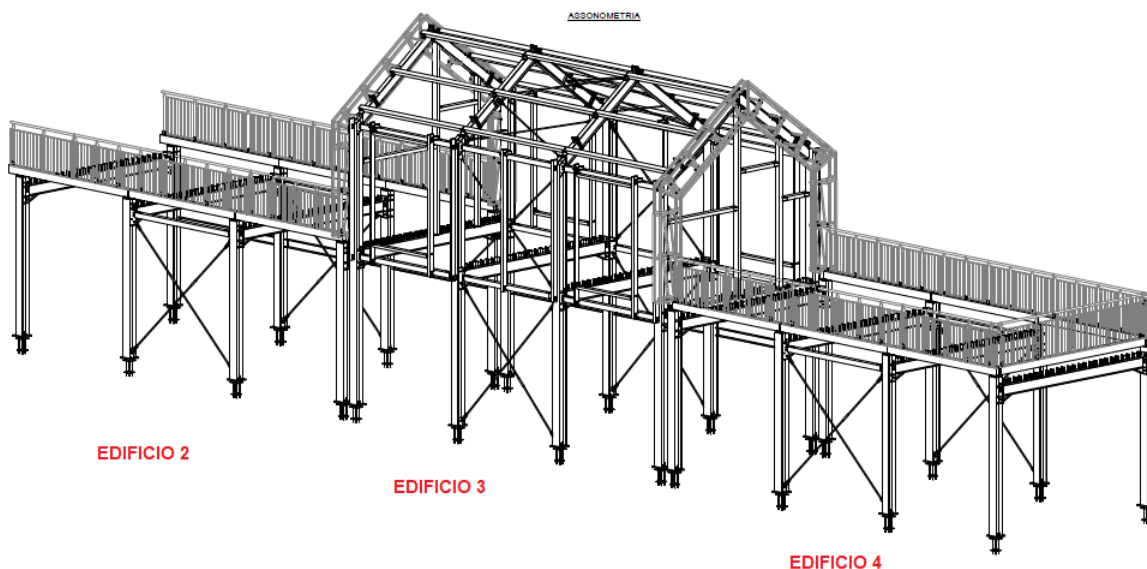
Ex-Galoppatoio – Assonometria Edificio 2-4
